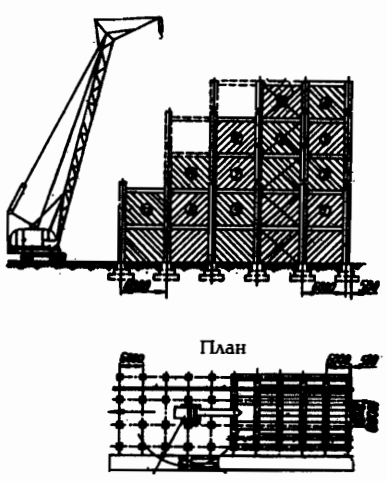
Технологическая схема ступенчатого монтажа ячеек здания при перемещении стрелового крана по продольной оси здания
